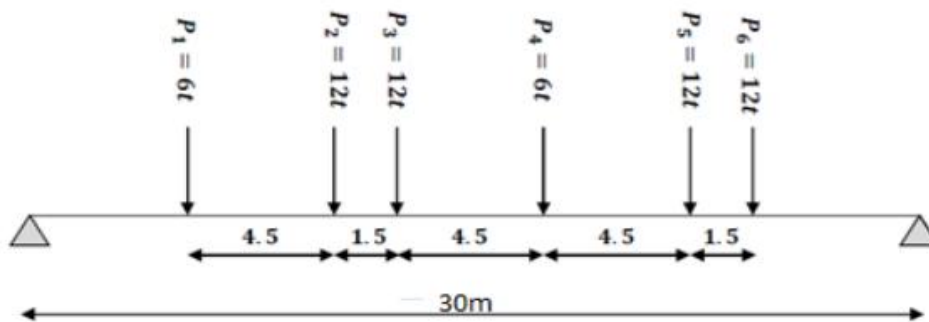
Système Bc disposition de deux camions sur la chaussée (sens longitudinale)
